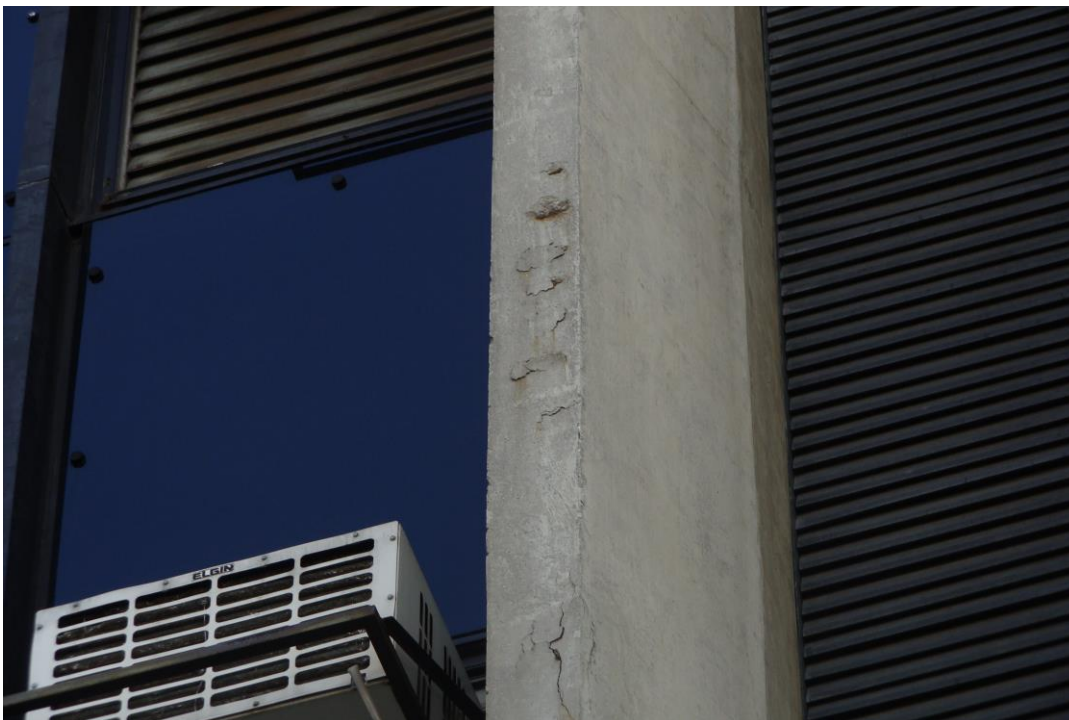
Armadura exposta pilar P13 (2º pavimento) (19/11/2013)
